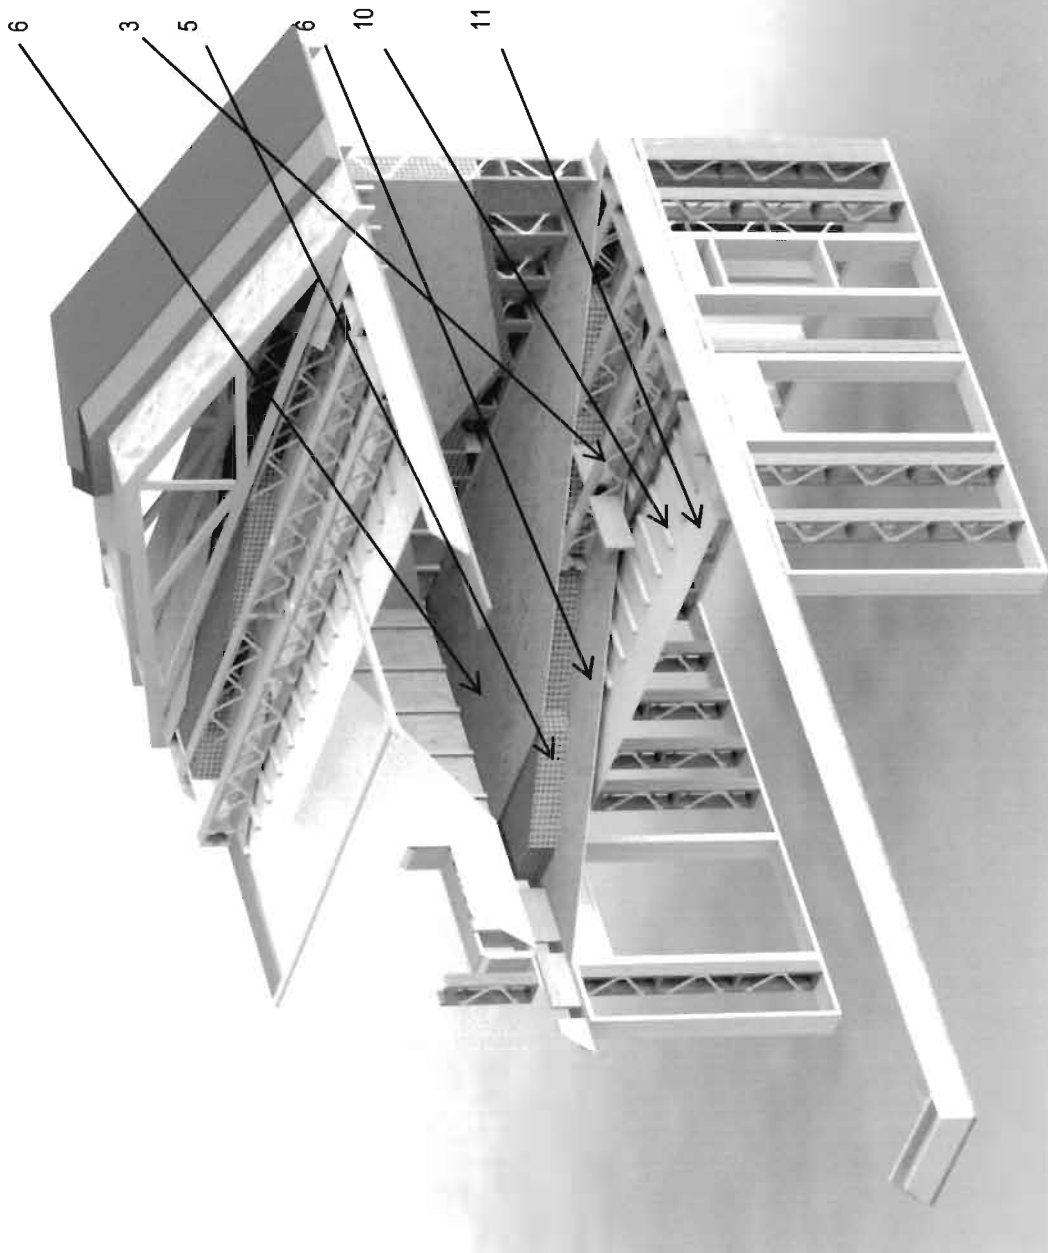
b STRUCTURĂ PERETE CAZE® 490mm
